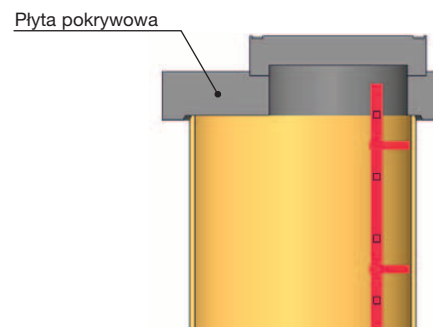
Betonowe elementy nadbudowy studni
